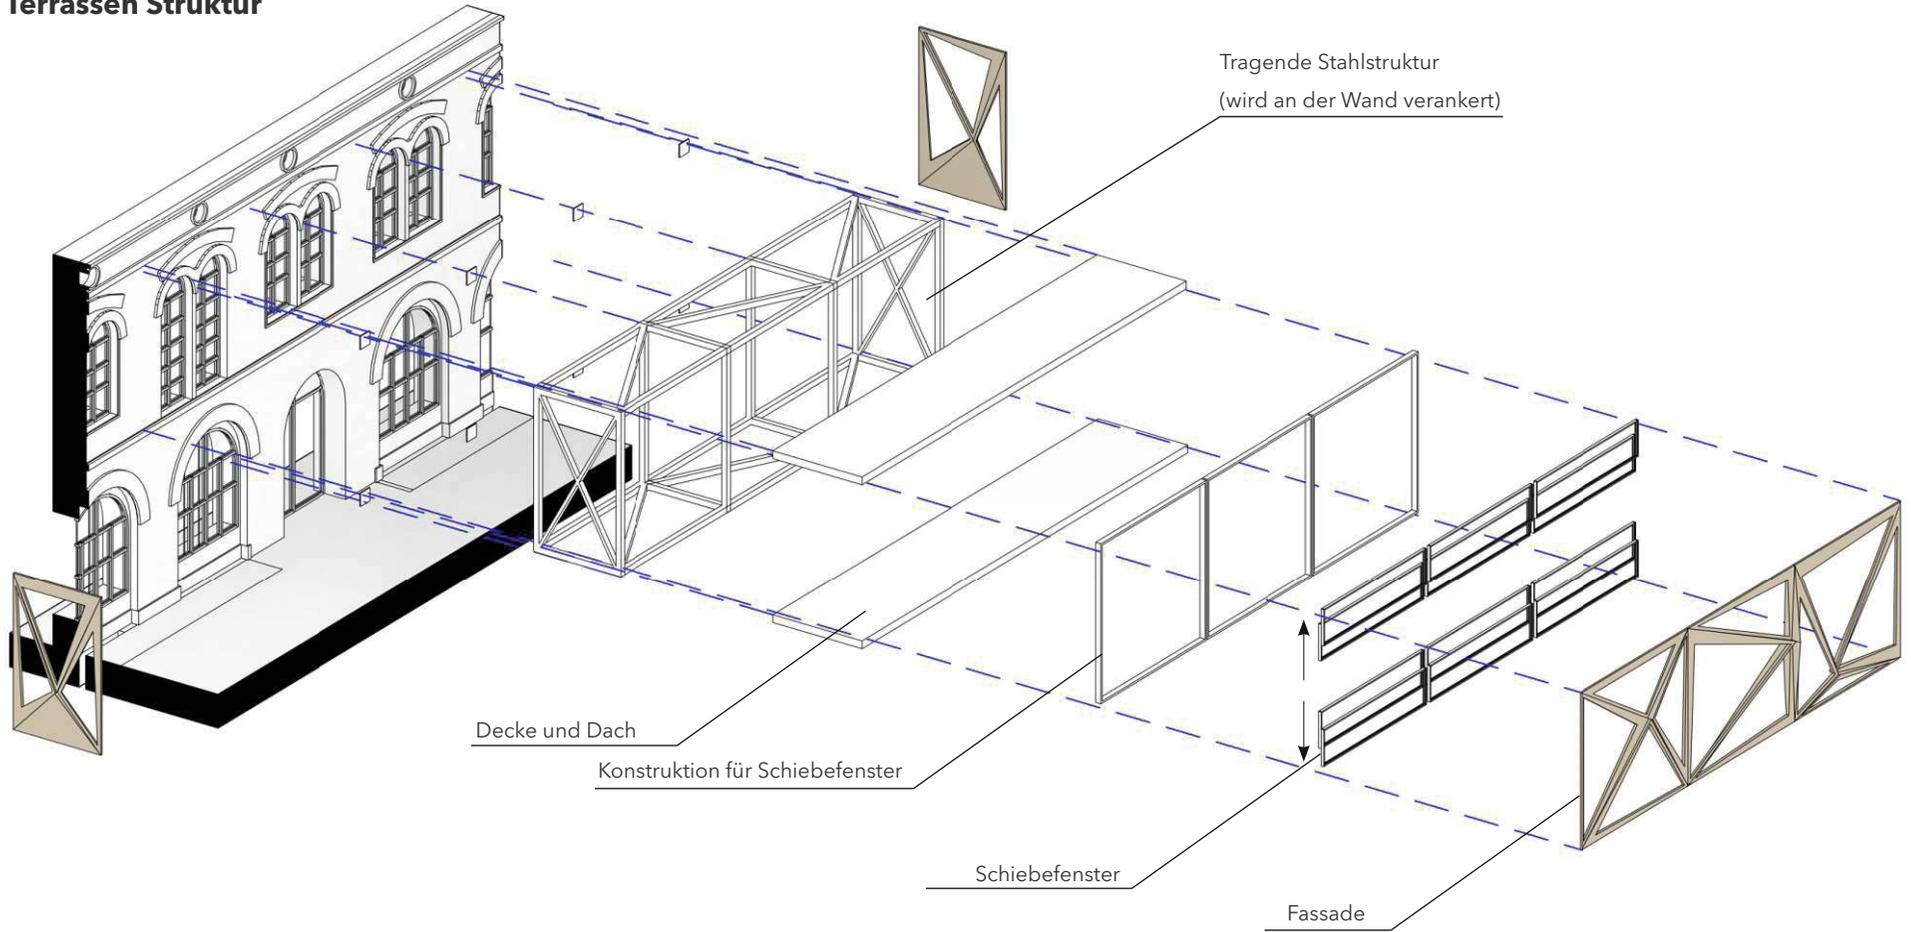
3D Axonometrie - Terrassenkonstruktion
